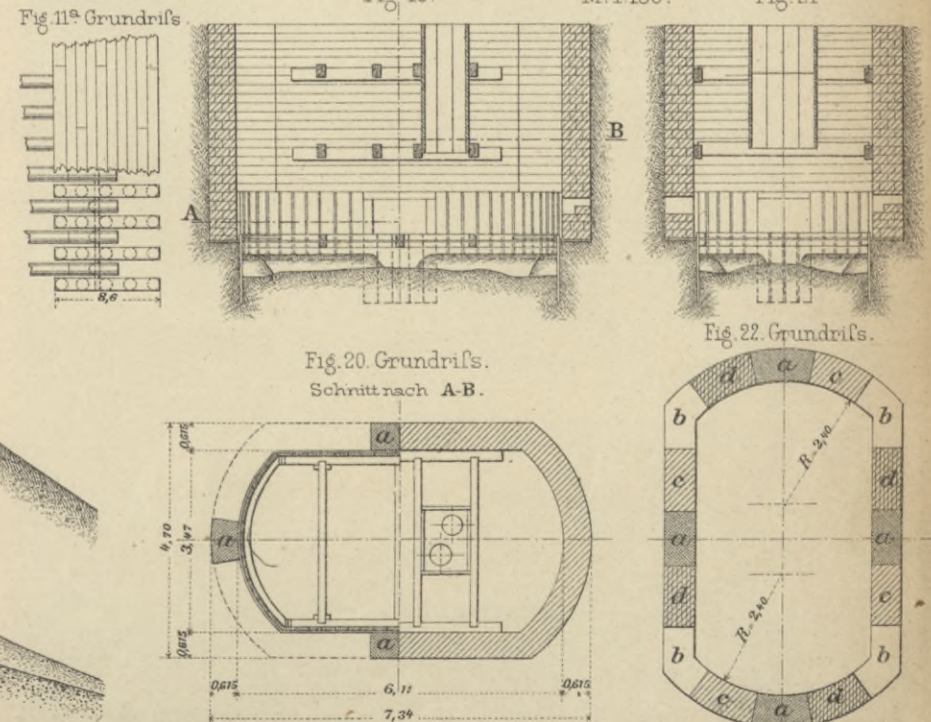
Brunnengründung des Schütthaldepfeilers der Kornhausbrücke in Bern.
